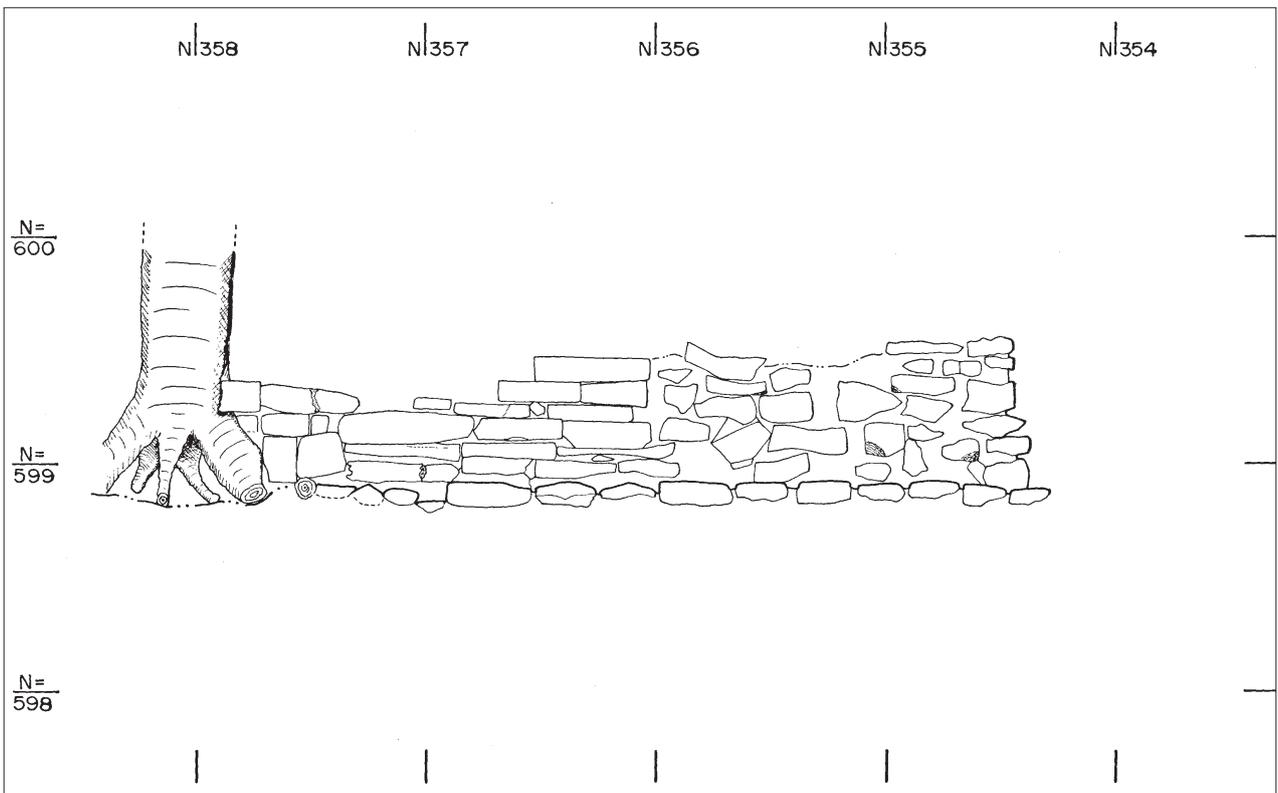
Fachada con vista al Este de basamento Oeste de estructura 9L-100
